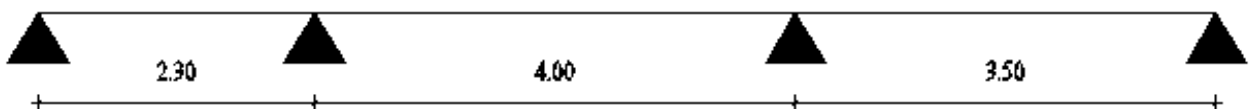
Schéma statique de poutrelles du 1^{er} type.
